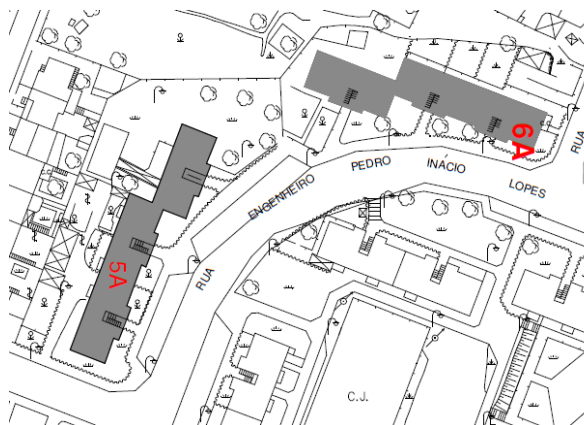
Planta de localização dos Blocos a serem intervencionados.
